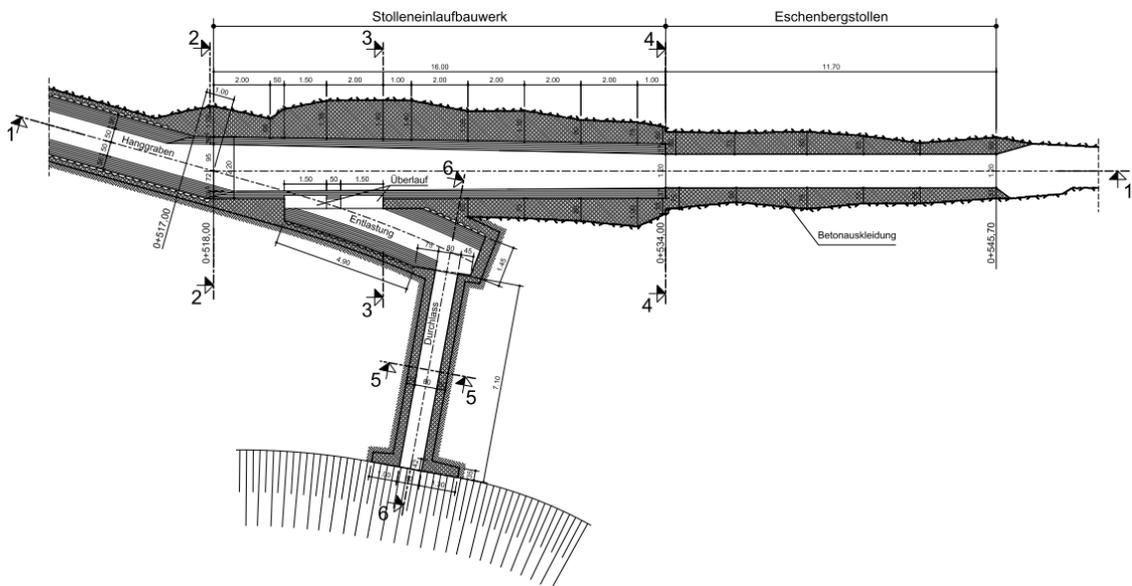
Großer Eschenberg-Stollen Einlaufbauwerk Grundriss
